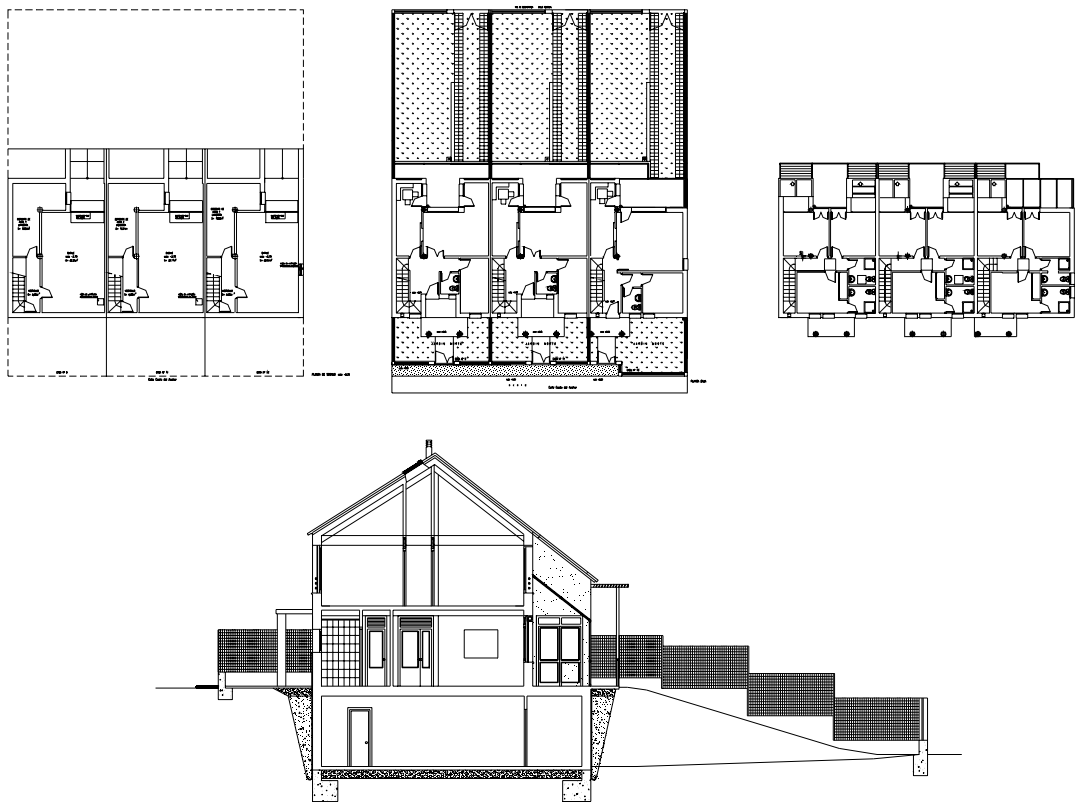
Plantas de sótano, baja, primera y sección de tres viviendas de bajo impacto ambiental en Valladolid.
